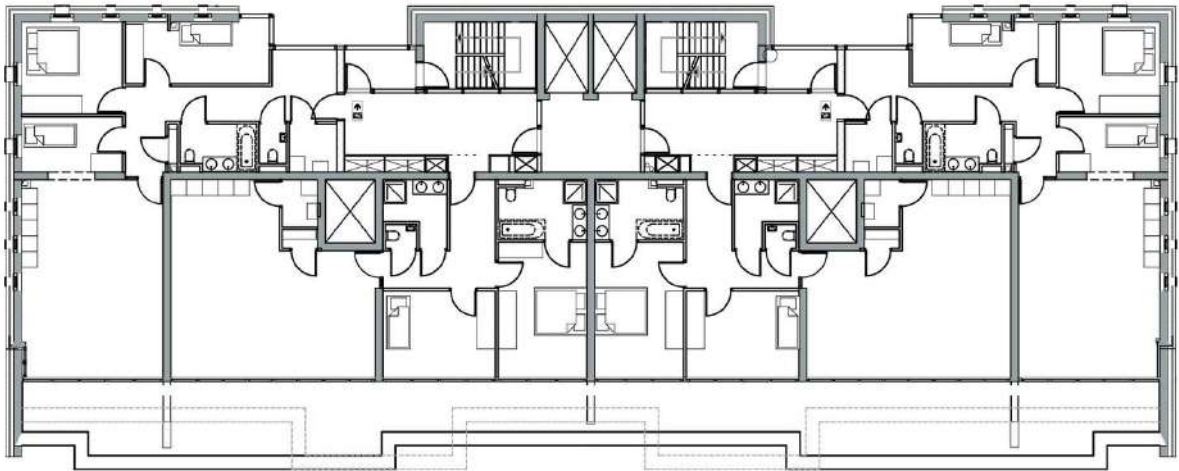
Приклад планування житлового комплексу, план 5 поверху [50]
